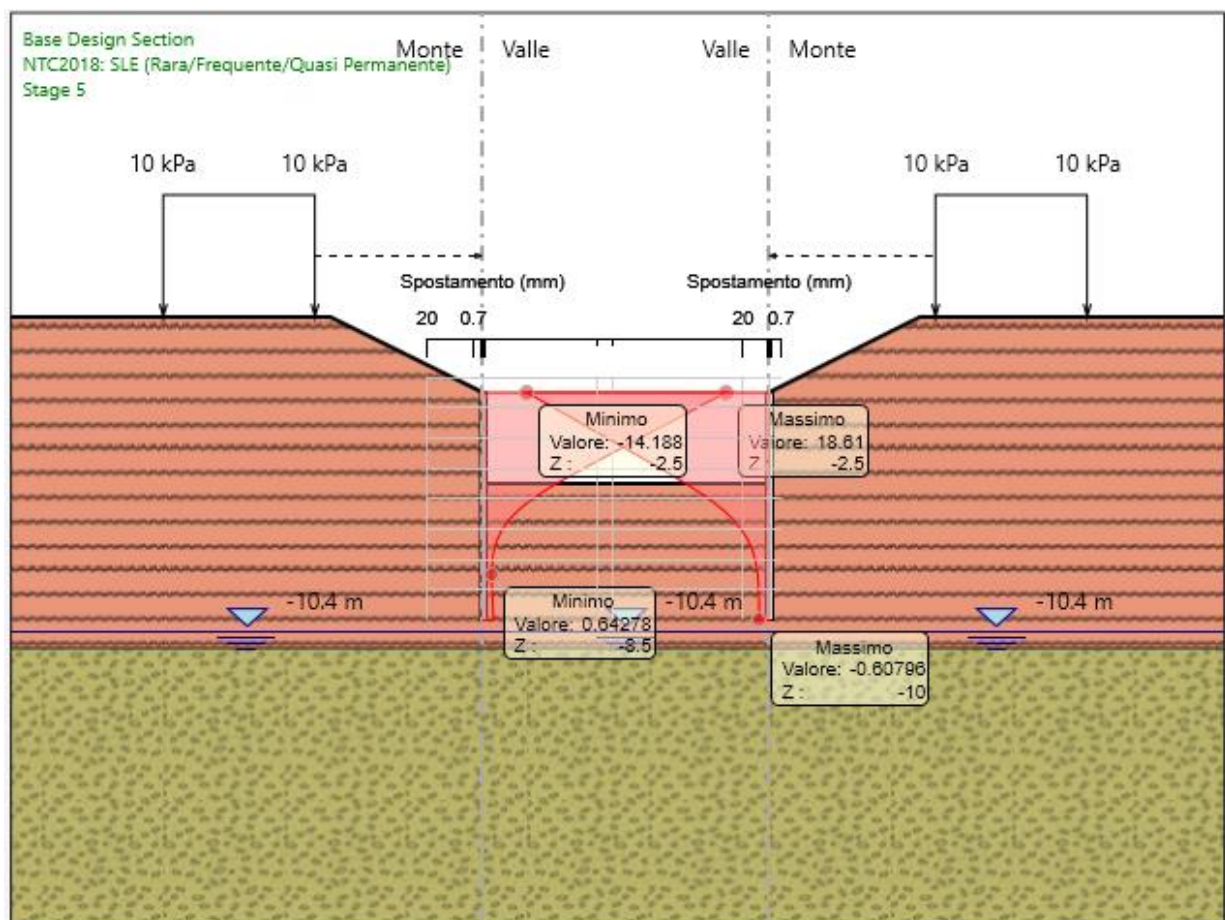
Sezione B: Spostamento massimo SLE (18.6mm)
